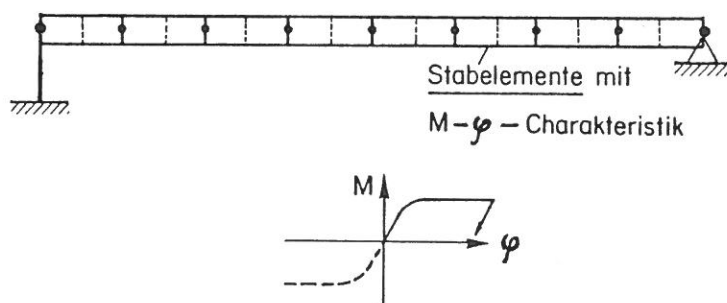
Abbildung eines Stahlbetonbalkens auf ein eindimensionales Balkenmodell /57/ mit finiten Elementen
